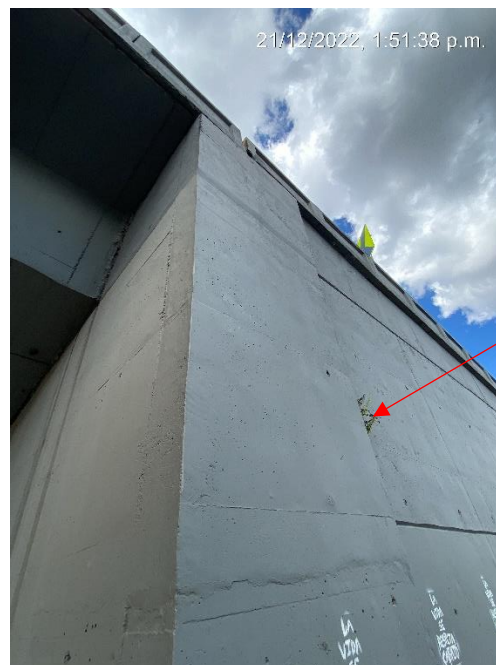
Vista Aleta Estribo Eje 1 Costado Derecho
